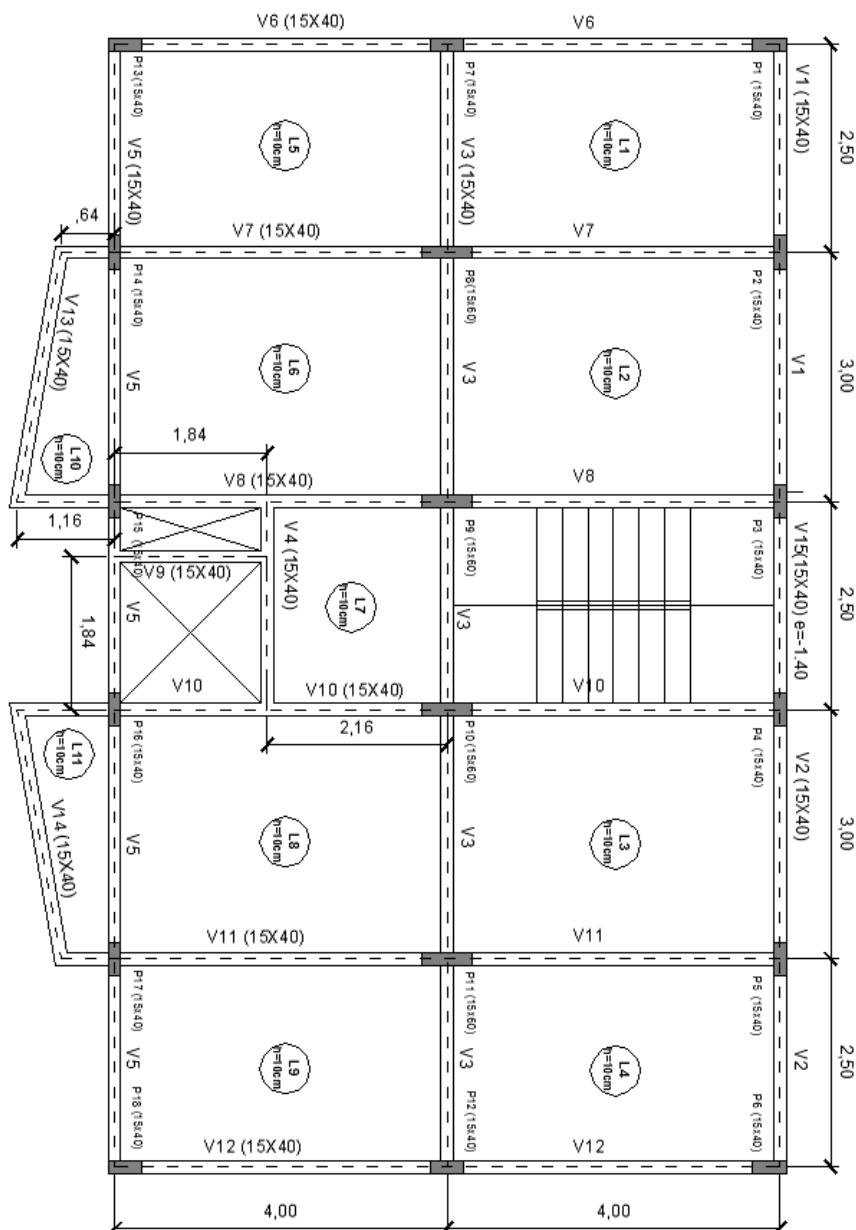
Planta de formas do pavimento tipo do exemplo 1, dimensões em metros (Desenvolvido pelo autor)
